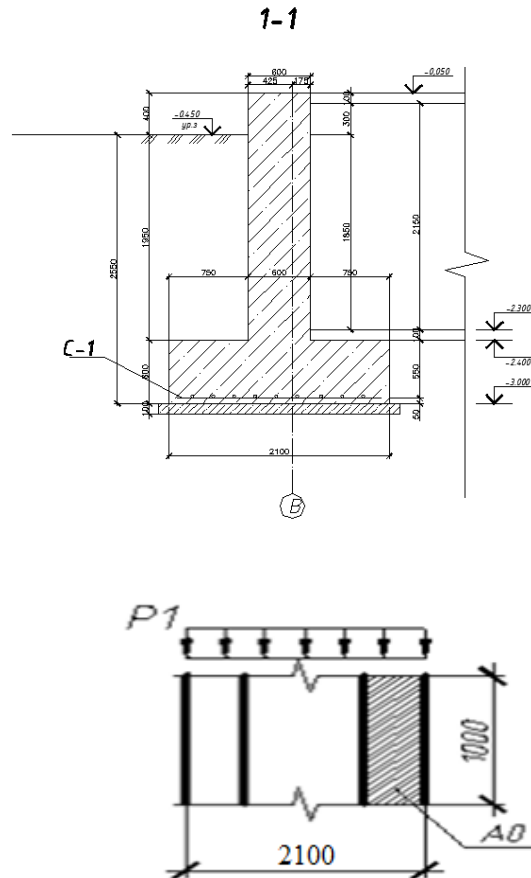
Схема для определения арматуры в фундаментной плите
